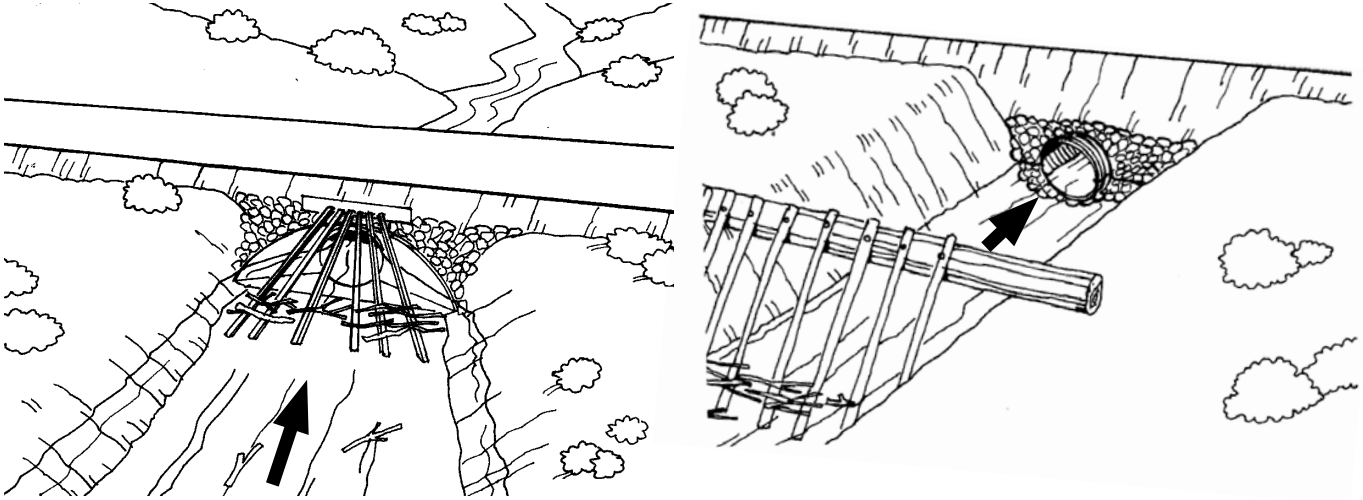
Use rejillas en las alcantarillas donde exista la posibilidad de una gran cantidad de escombros en el cauce. Recuerde que las rejillas necesitan limpiarse y darles mantenimiento.
